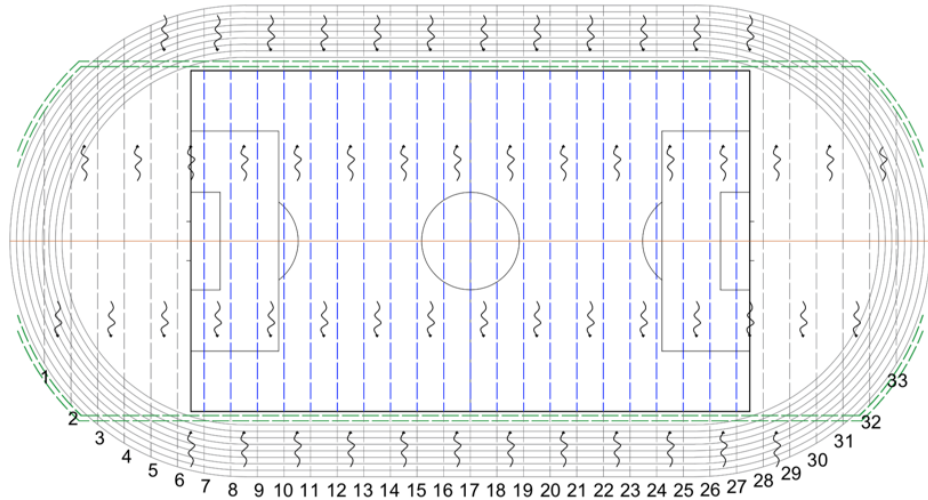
Detail Lapis Lapangan Sepak Bola
